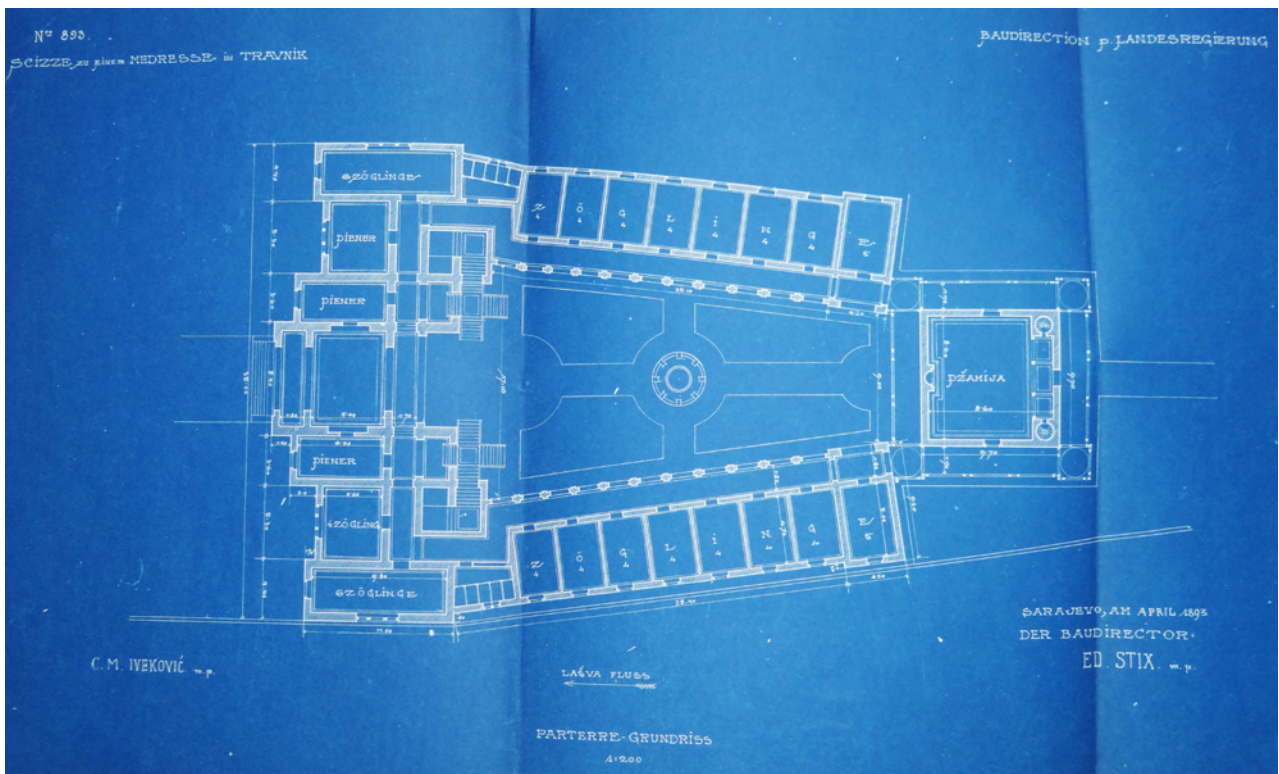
o. Travnik, Medresa, Parterre-Grundriss von Ćiril Iveković aus Plansatz „Scizze zu einer Medresse in Travnik“, Blaupause, April 1893. Quelle: ArBiH, GDZVS 1878-1918.
